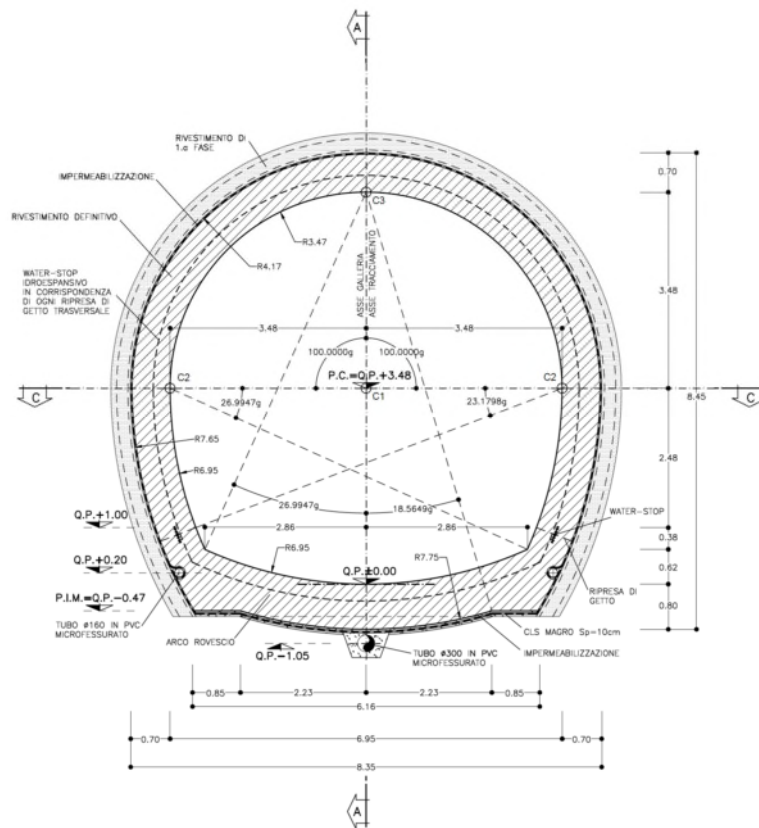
Sezione Tipo B2P – Carpenteria – Sezioni
